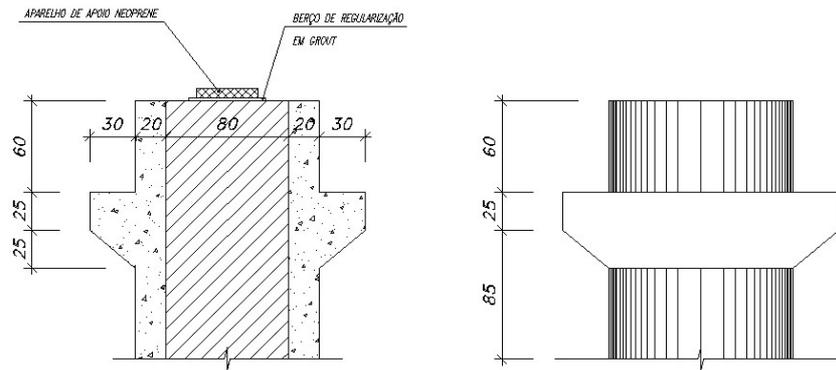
Detalhe de reforço de pilar incluindo console para troca de aparelho de apoio.
